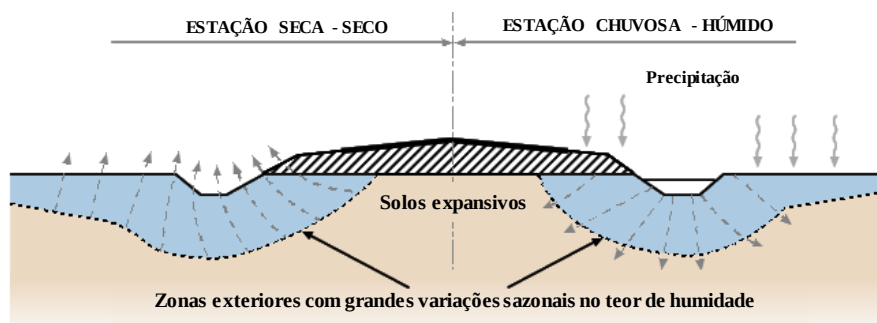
Movimentos da humidade em solos expansivos sob um pavimento de uma estrada (adaptado de MTPW, 2013 b)
